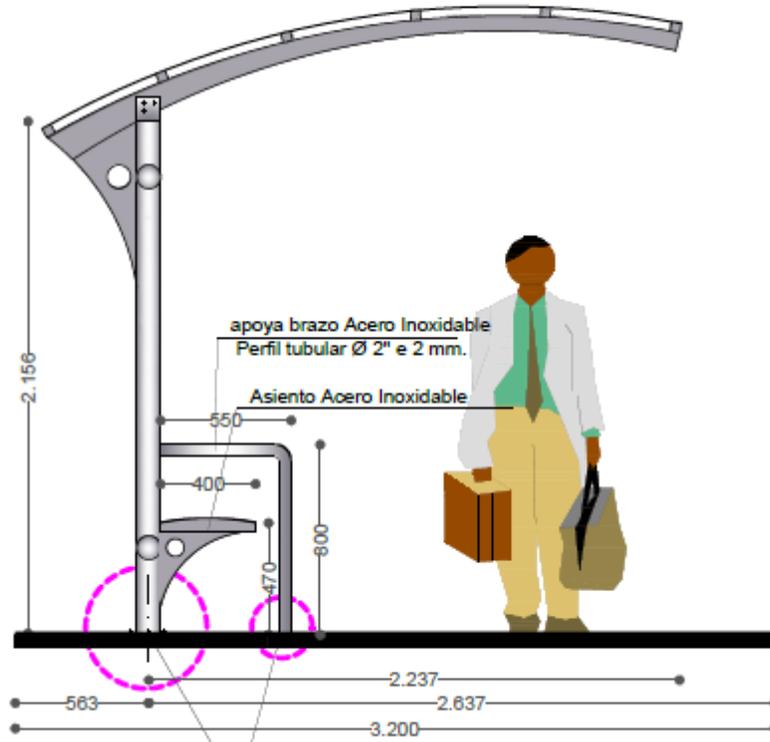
Elevación frontal – paradero doble (11 Oriente 1 Sur, lado Ote)
